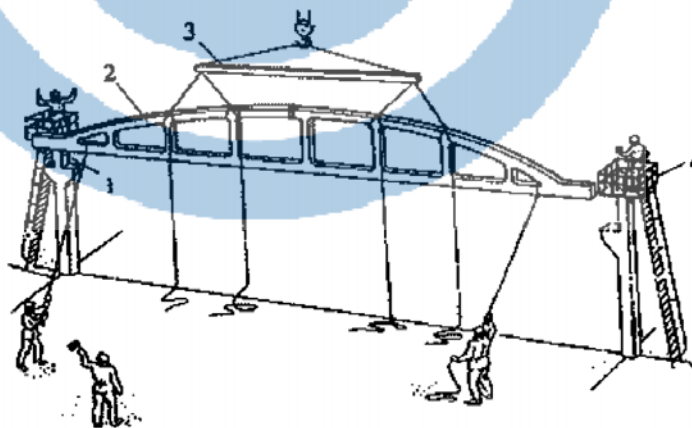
Процесс монтажа фермы. Монтаж и закрепление ферм на опорах колонн 1 - оттяжка; 2 - ферма; 3 - траверсы; 4 - лестница.
